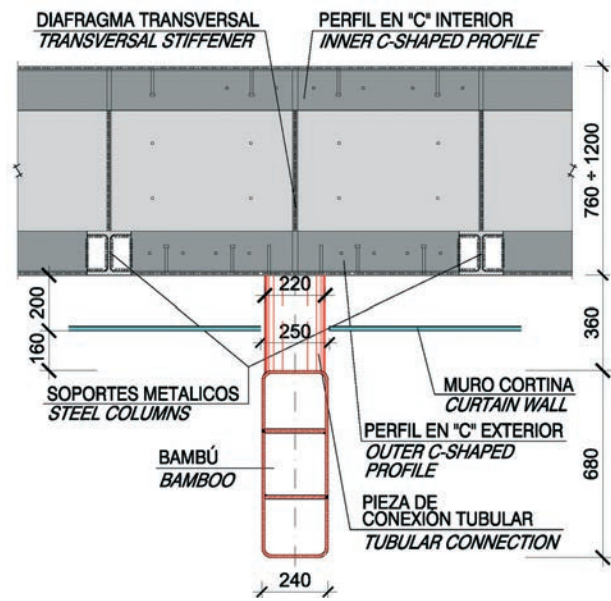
Planta de la conexión de los bambúes a las vigas de patio (cotas en mm)
